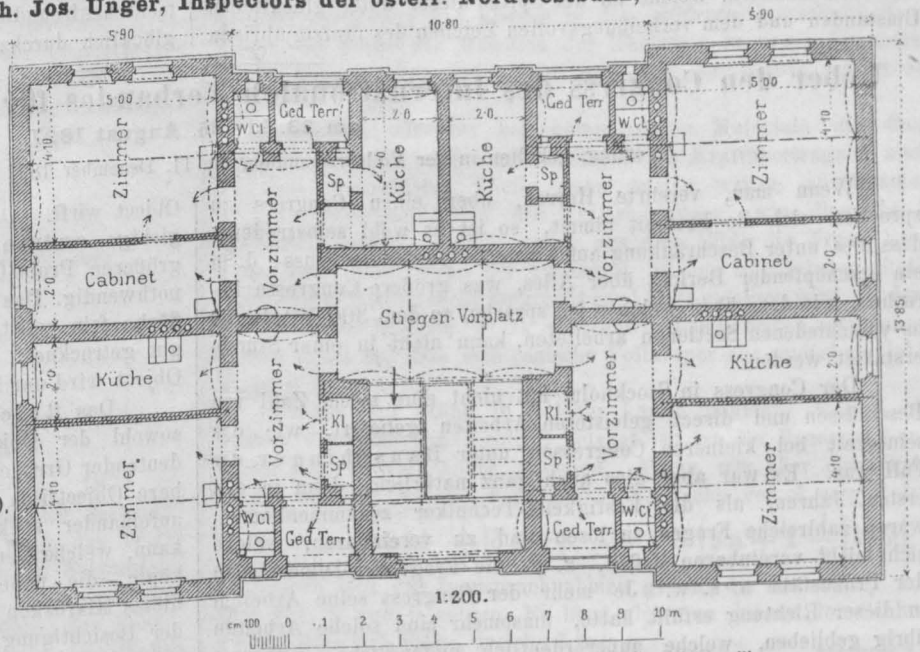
Grundriss eines freistehenden Wohnhauses für 16 Familien.
